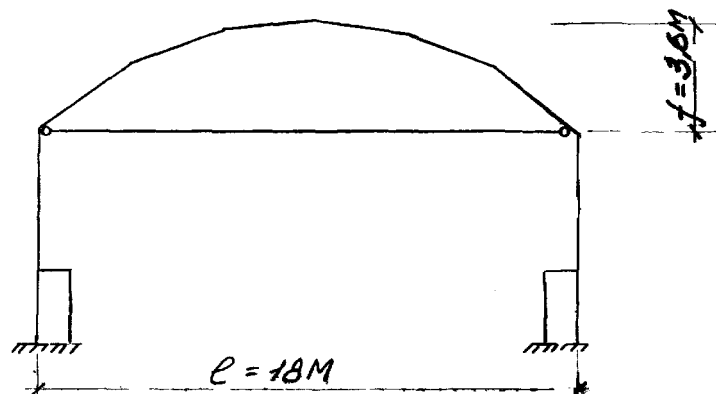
Розрахункова схема арка з затяжкою безшарнірної з жорстким обпиранням на колону.
